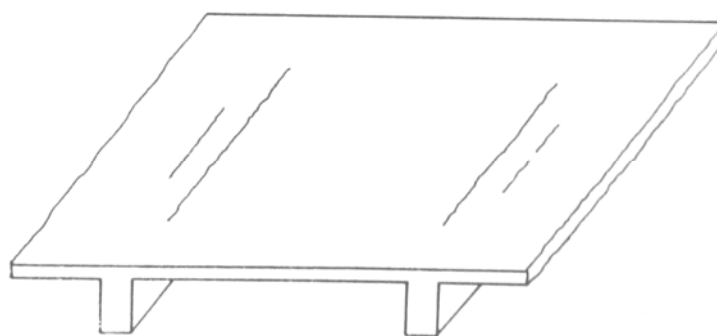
Trincas na face superior da laje devidas à ausência de armadura negativa.
